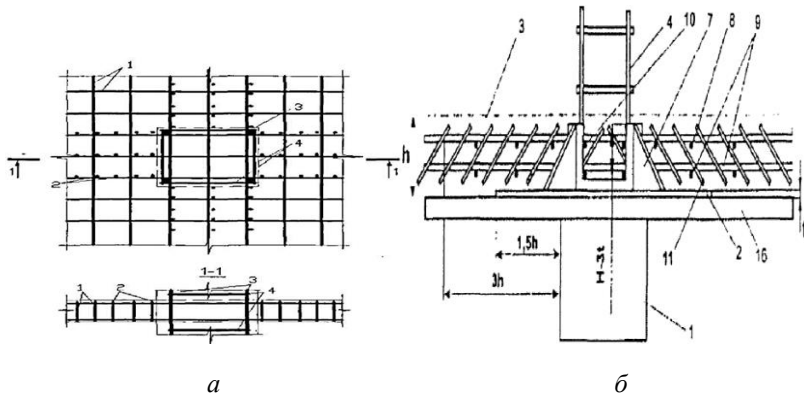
Армування вузлового з'єднання «плита-колонна» поперечною арматурою: а) вертикальною; б) похилою
